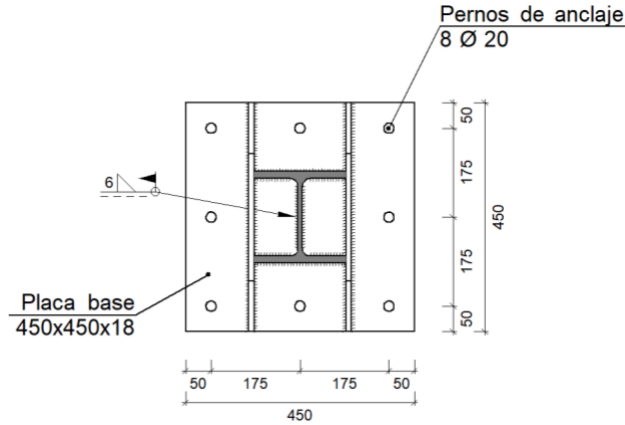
Planta de la unión placa base-pilar. Fuente: CYPE 3D.
